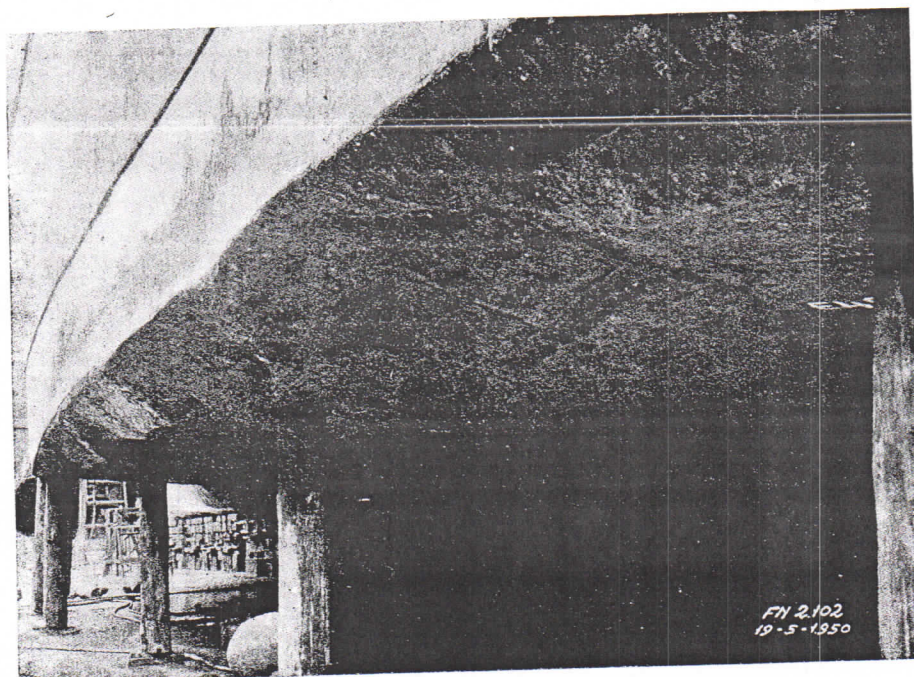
Vista del fondo mostrando las abolladuras.
